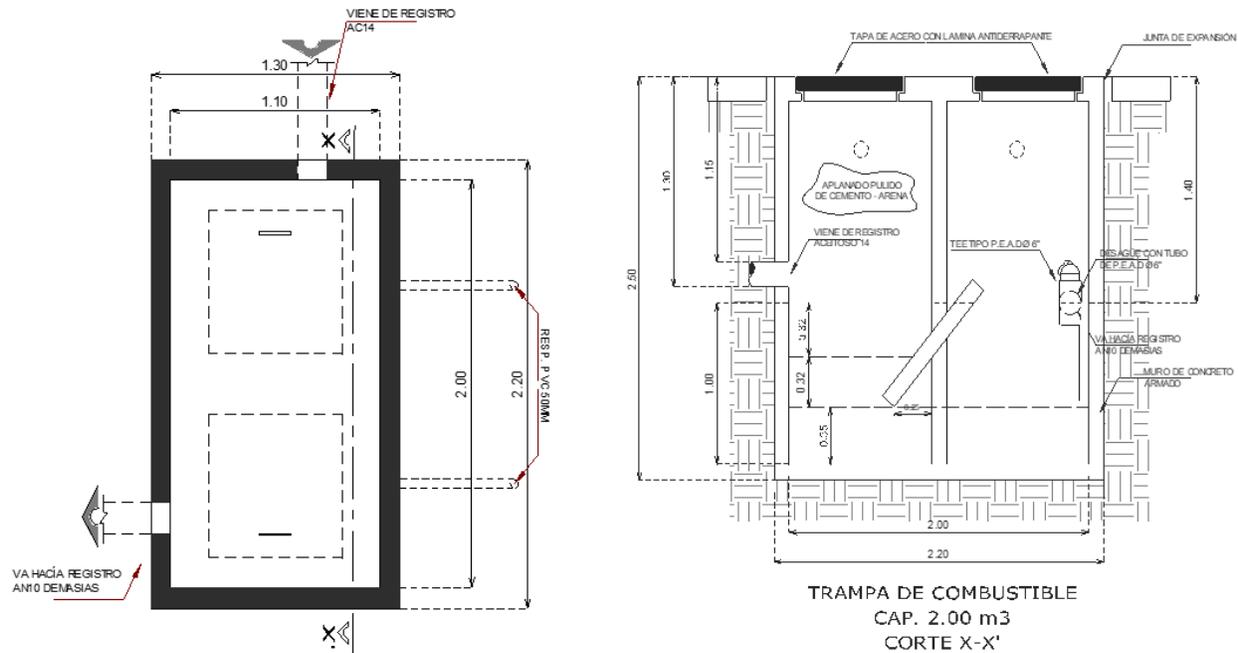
Vista en planta y corte de trampa de combustibles.
